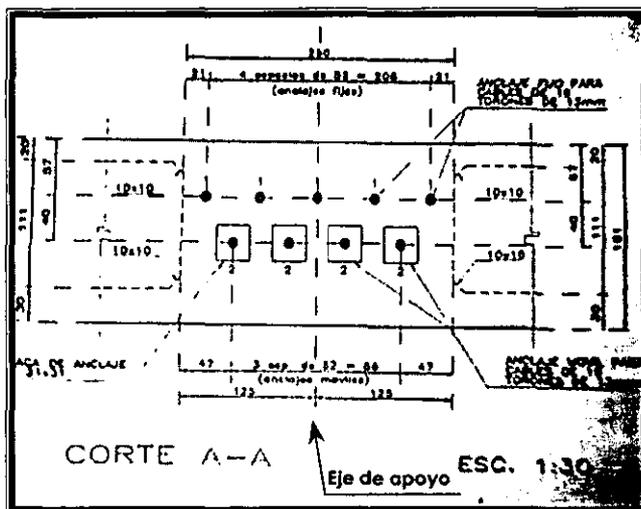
Posición de los cables de presfuerzo en la nervadura central sobre la pila.
